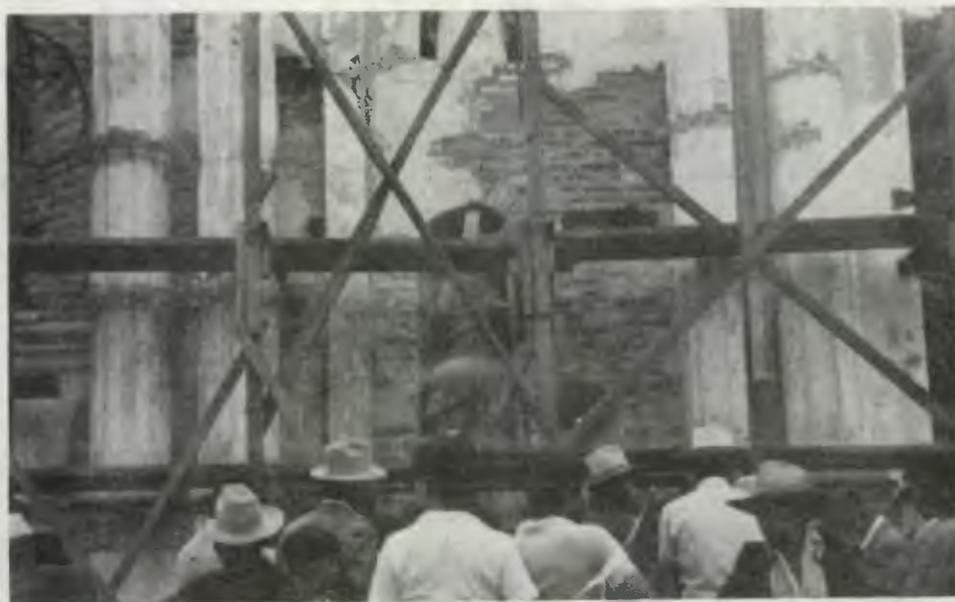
Puti de la fachada, ángulo inferior, lado derecho.
